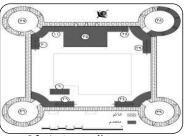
مسقط أفقى للدور الأول لقلعة آبار الغنم (رسم بمعرفة الباحث)
